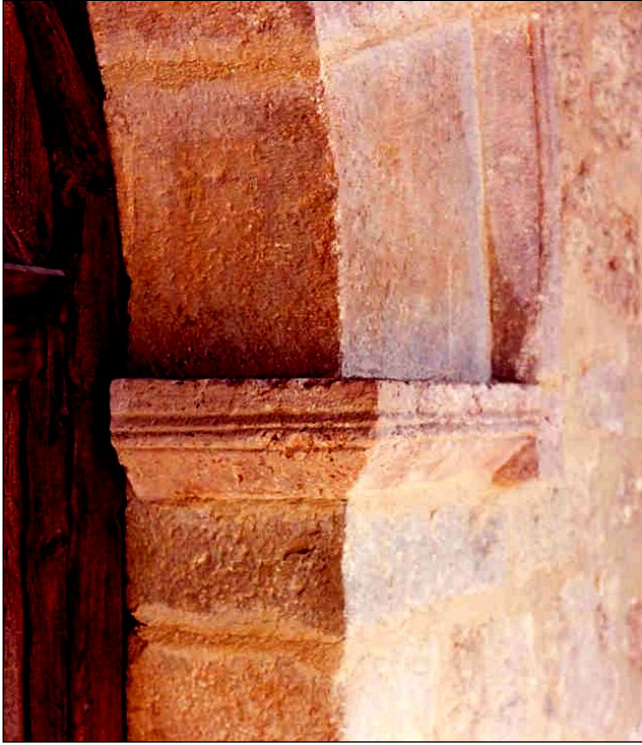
Detalle moldura imposta izquierda y arranque del guardapolvo.
